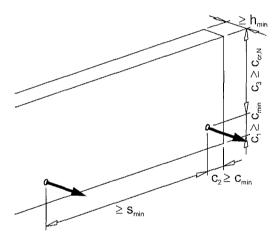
Einbausituation Wandfläche - Zugbeanspruchung, ohne Rückhängebewehrung
